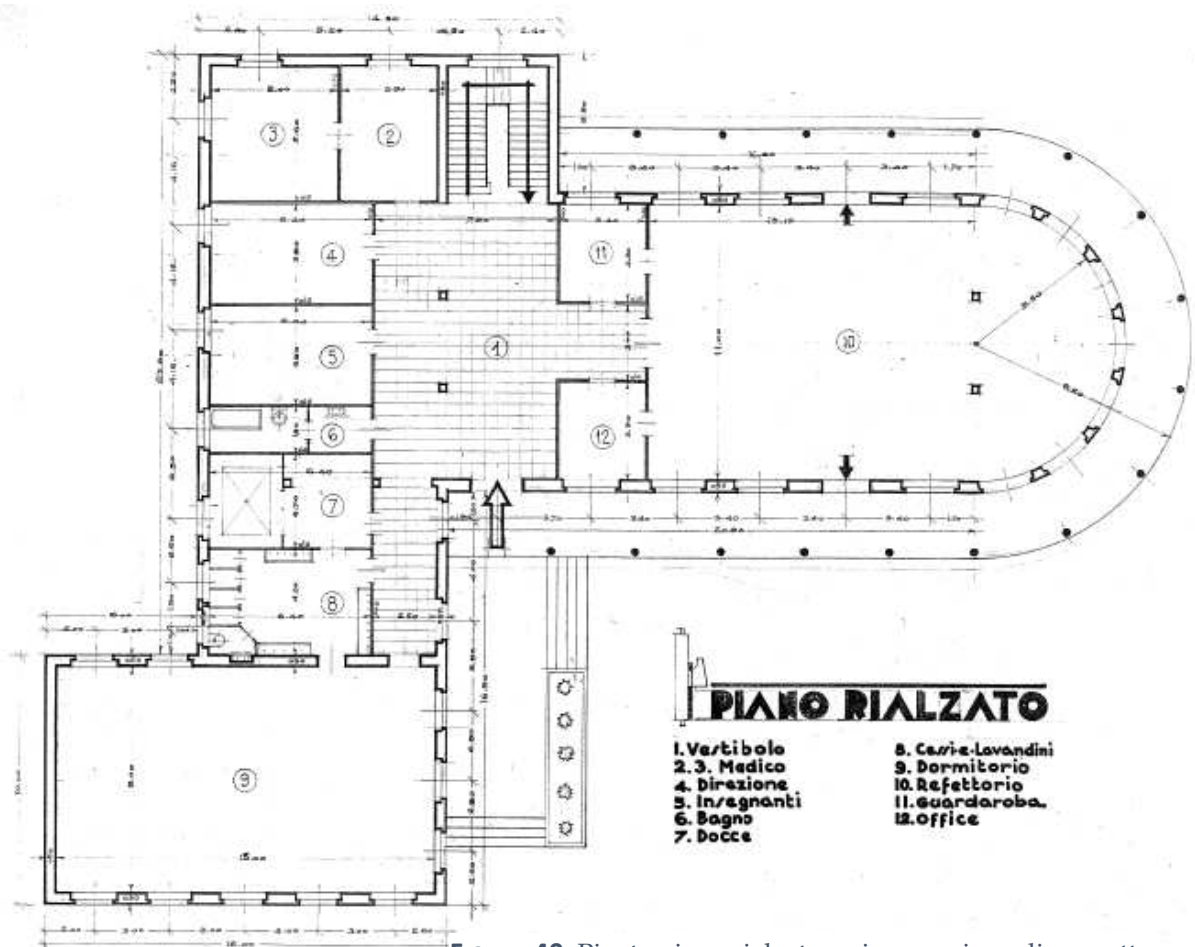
Pianta piano rialzato, prima versione di progetto
